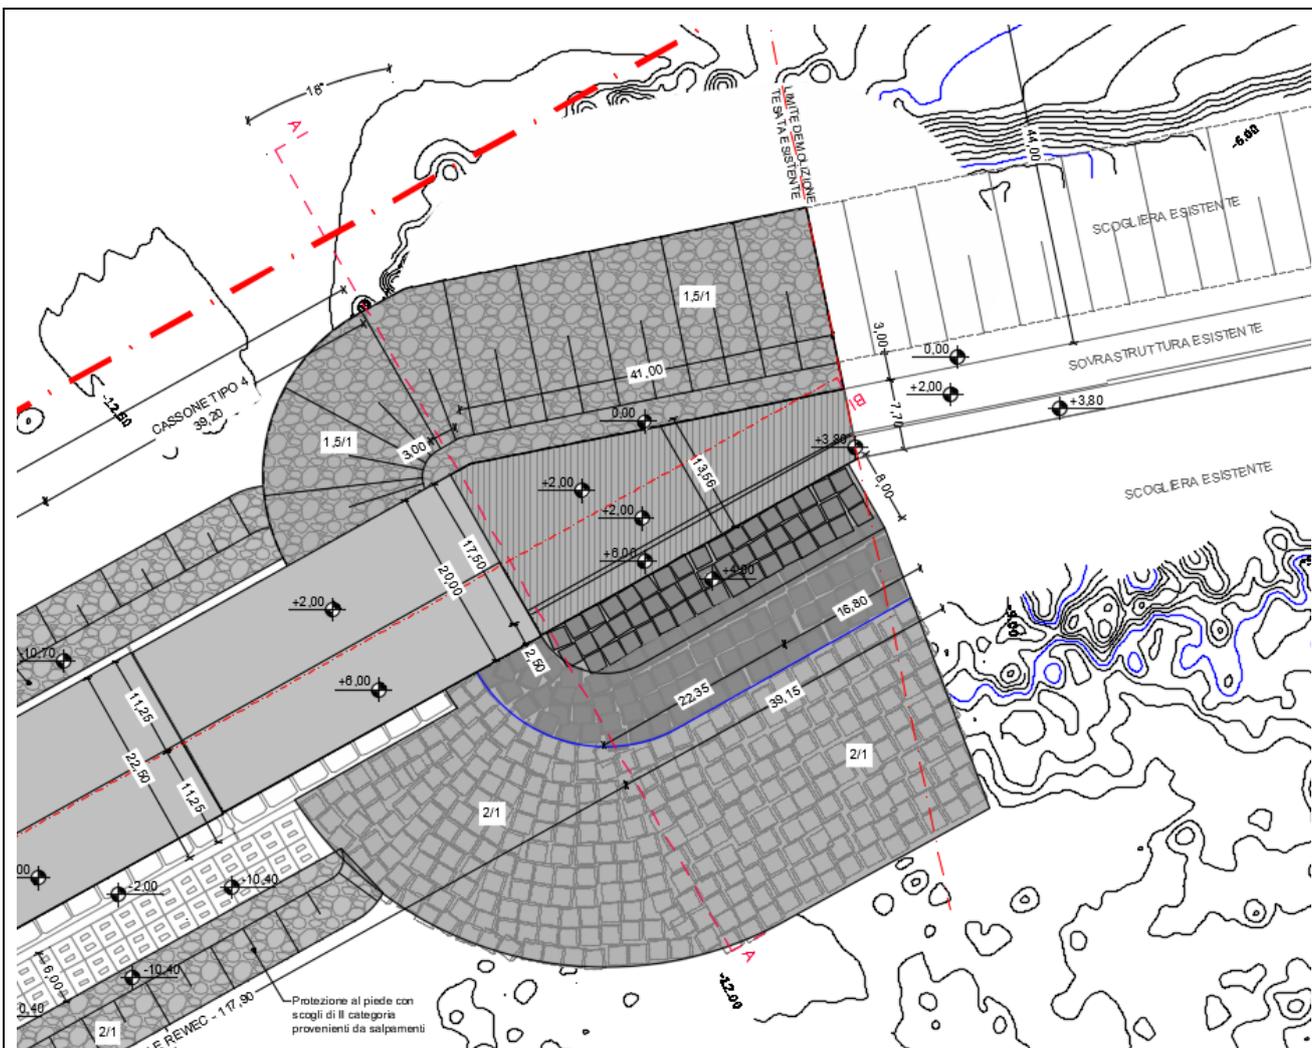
Soluzione di Variante: Prolungamento Molo Sopraflutto – stralcio planimetrico raccordo
